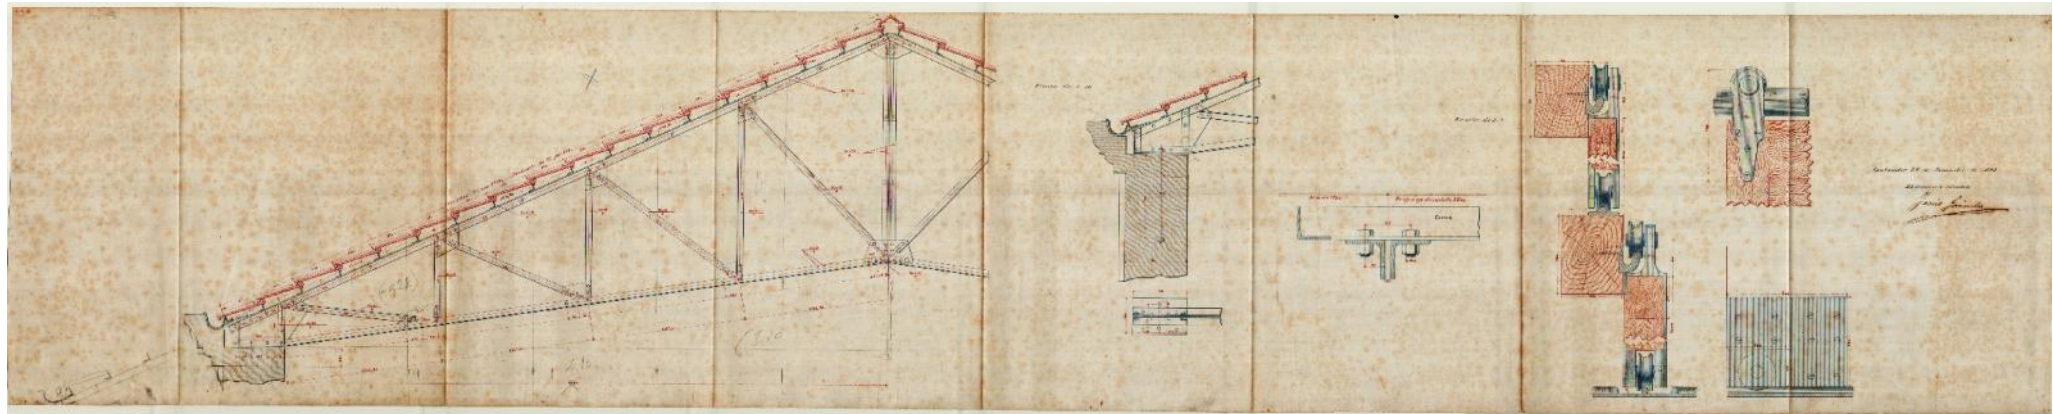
Hoja 2ª: Detalles de la armadura y puertas. Contenido en el Proyecto de 1901.
